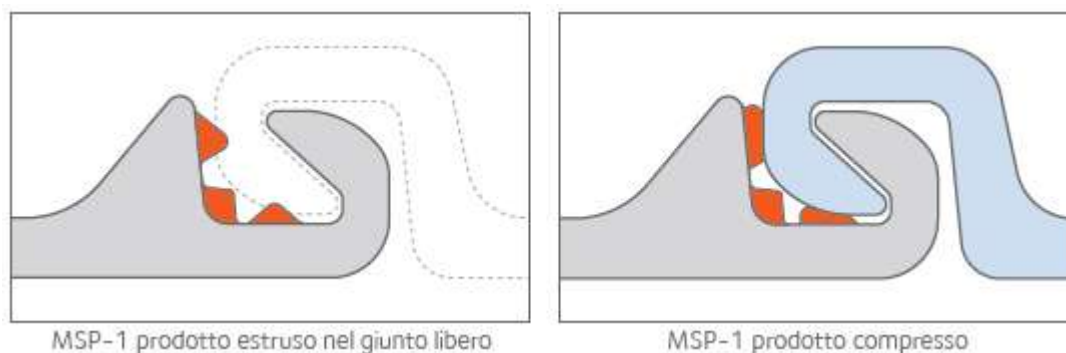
Sistema di impermeabilizzazione dei giunti
